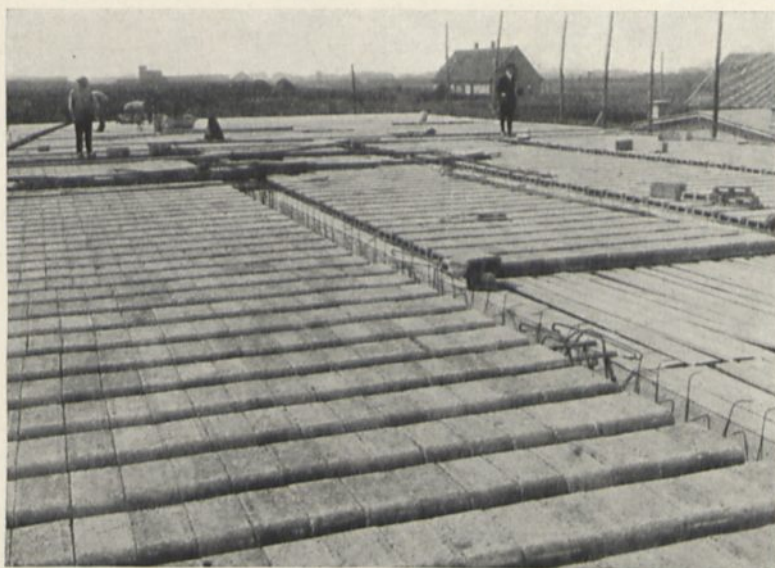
Stallgebäude in Connhausen. Ausführung der Bimsbetonhohlkörperdecken.
